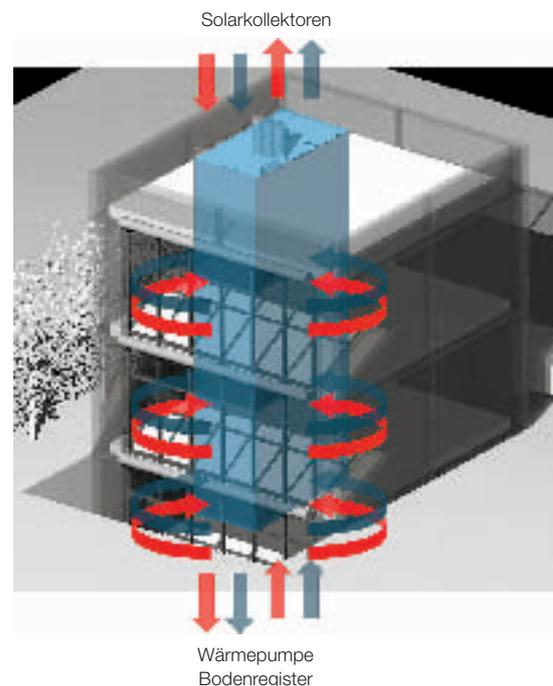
Spannbeton-Fertigdecken mit Betonkernaktivierung
